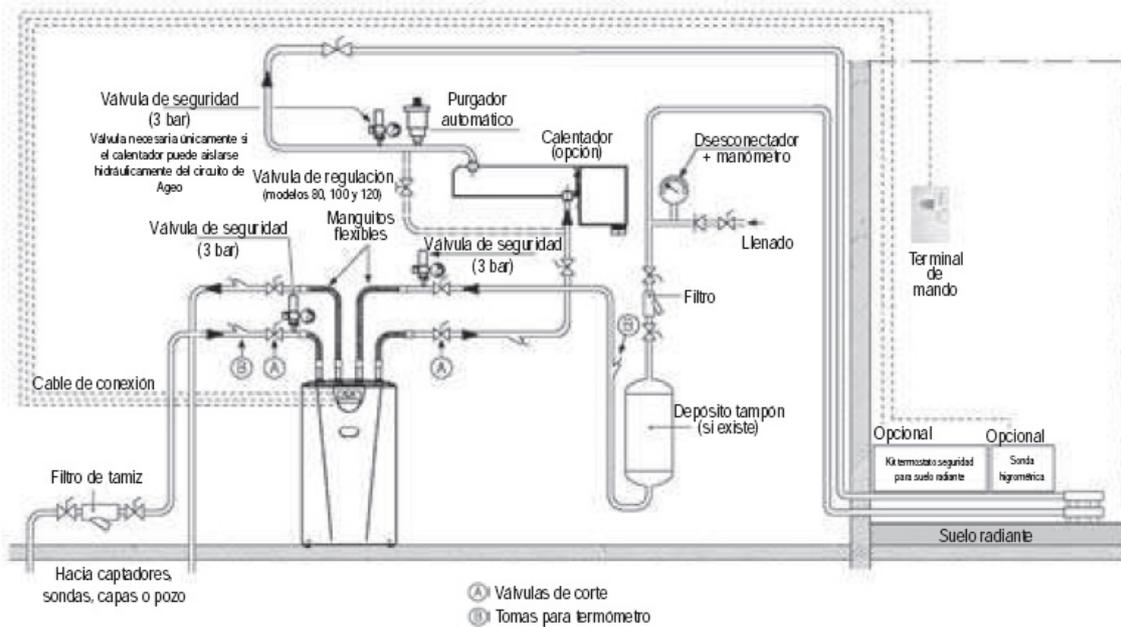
Esquema hidráulico de montaje del fabricante CIAT.
